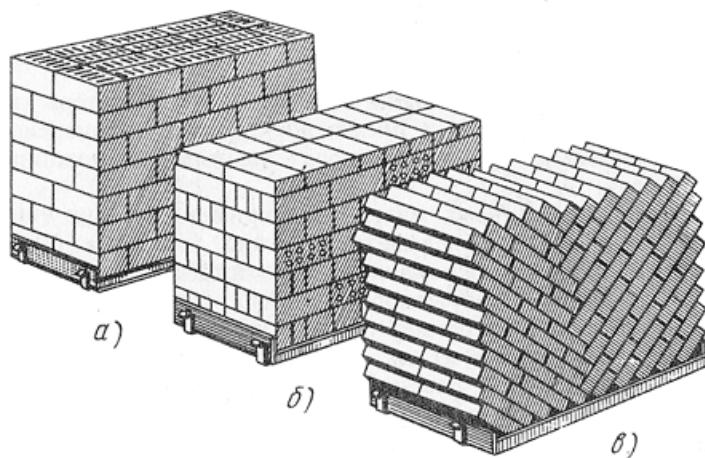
Укладка на поддонах кирпича с перевязкой
